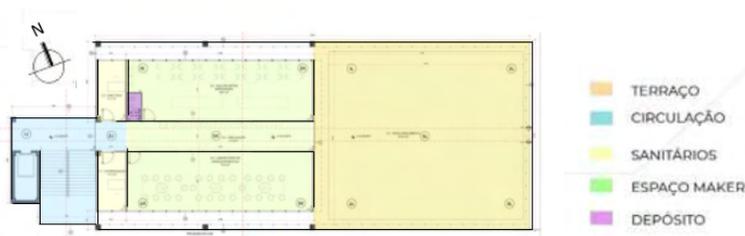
Zoneamento tipológico pavimento da *Escola B
